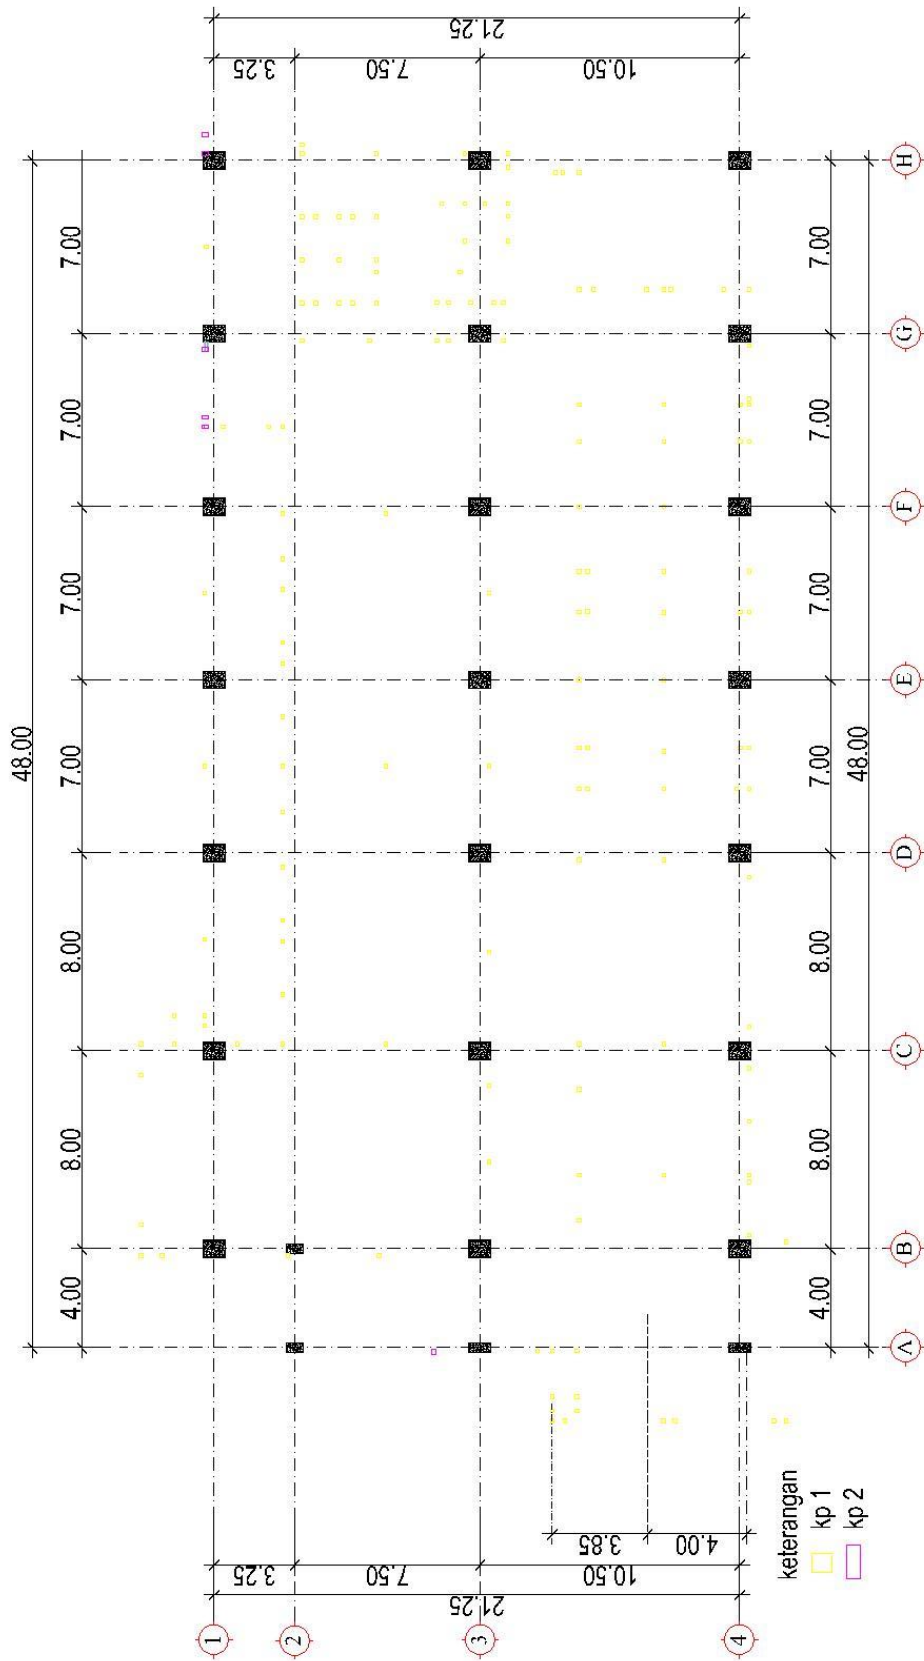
Denah Rencana Kolom Elv. +14.04
